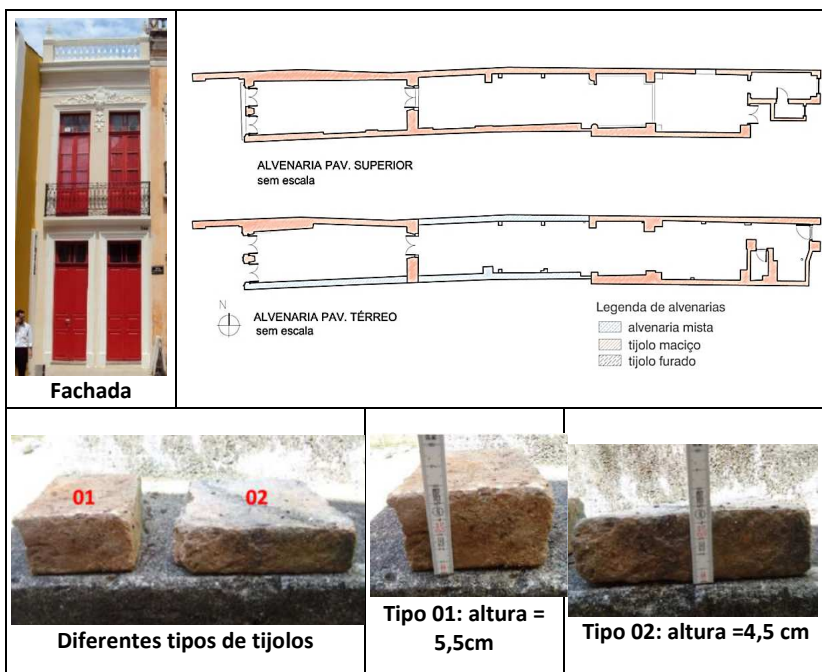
Tipo de alvenarias existentes na edificação Teatro Grupo Armação (IC008)
